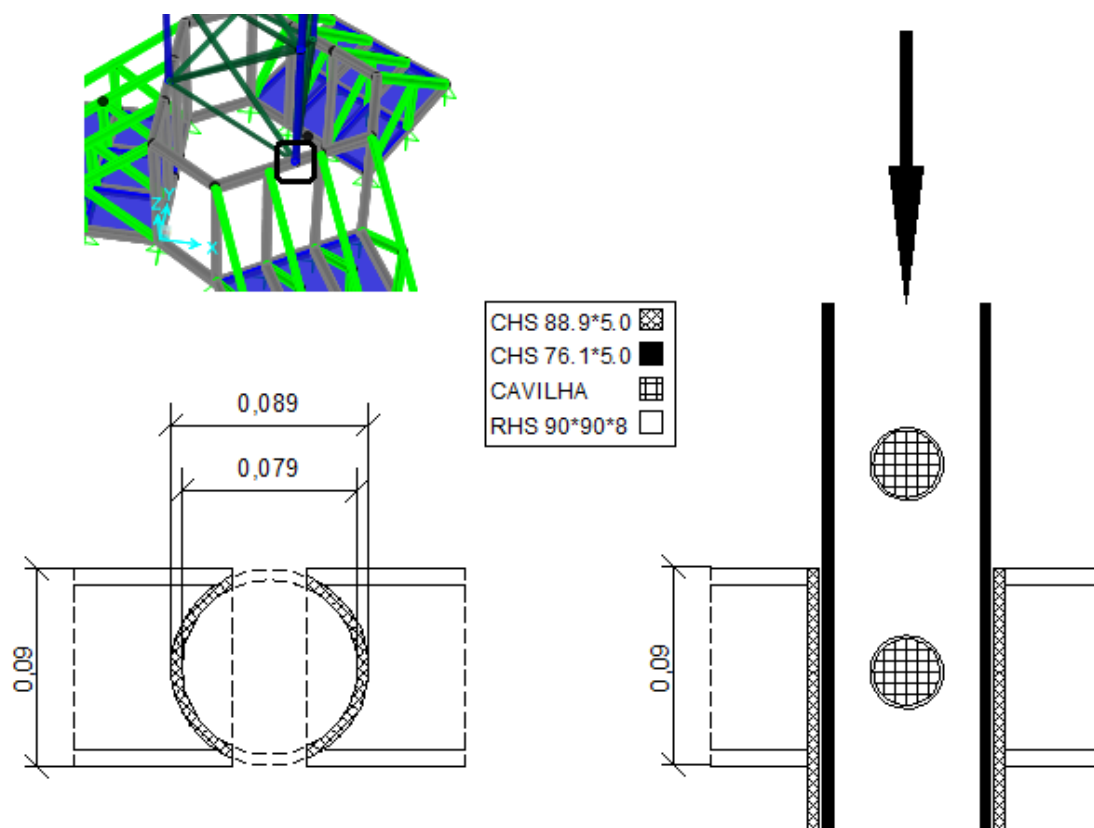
Pormenor da ligação do mastro com a estrutura de suporte
